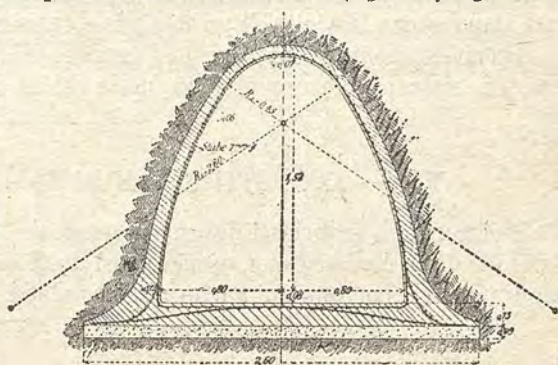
Sezione di un canale costruito col sistema Monier.
